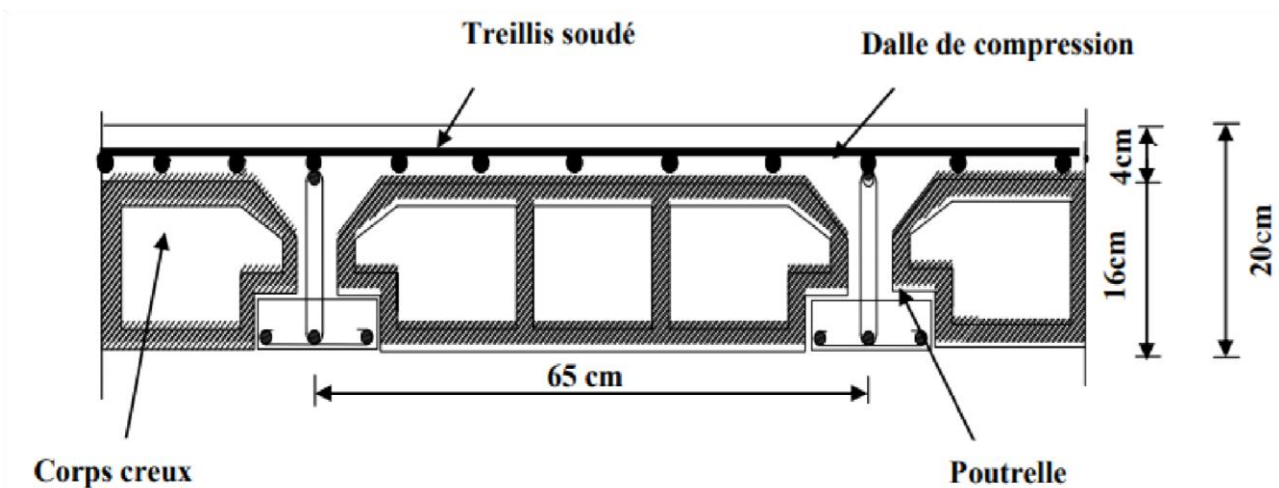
Coupe verticale d'un plancher en corps creux.
